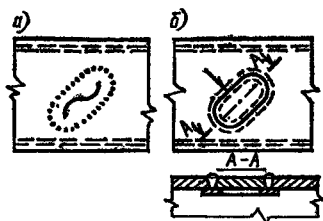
Устранение трещин в сварных стержнях двустенчатого сечения установкой вставки; а — положение трещины и разметка под вырезку; б — заварка
